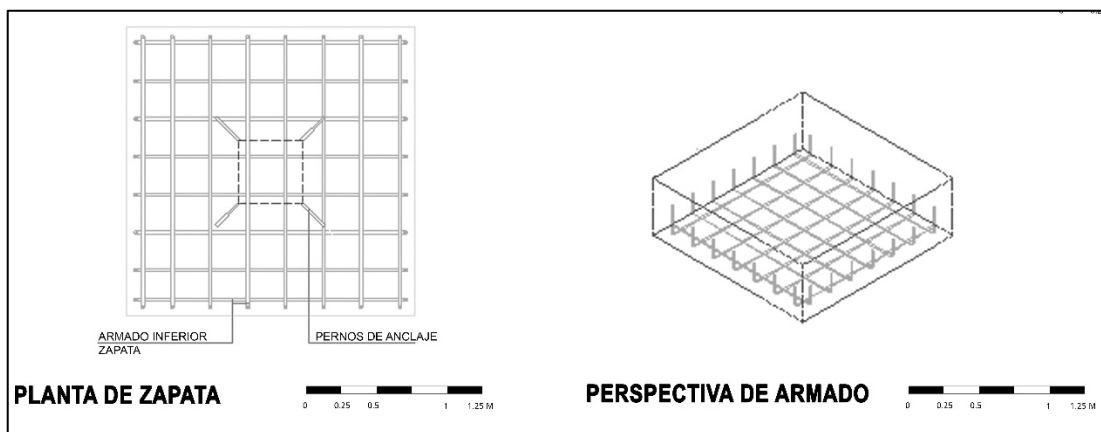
Detalles de zapata aislada y de pilar metálico
